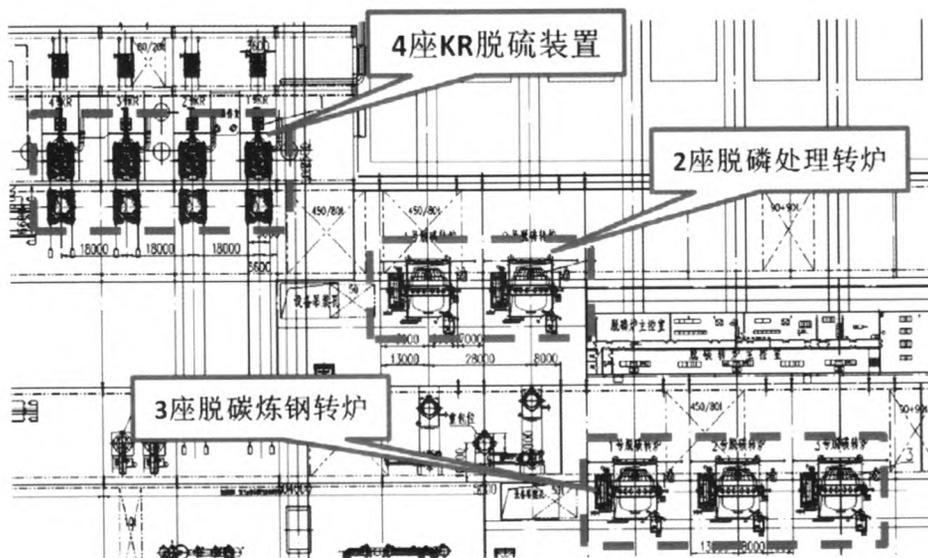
首钢京唐公司炼钢厂铁水预处理与转炉炼钢工序平面布置示意图
